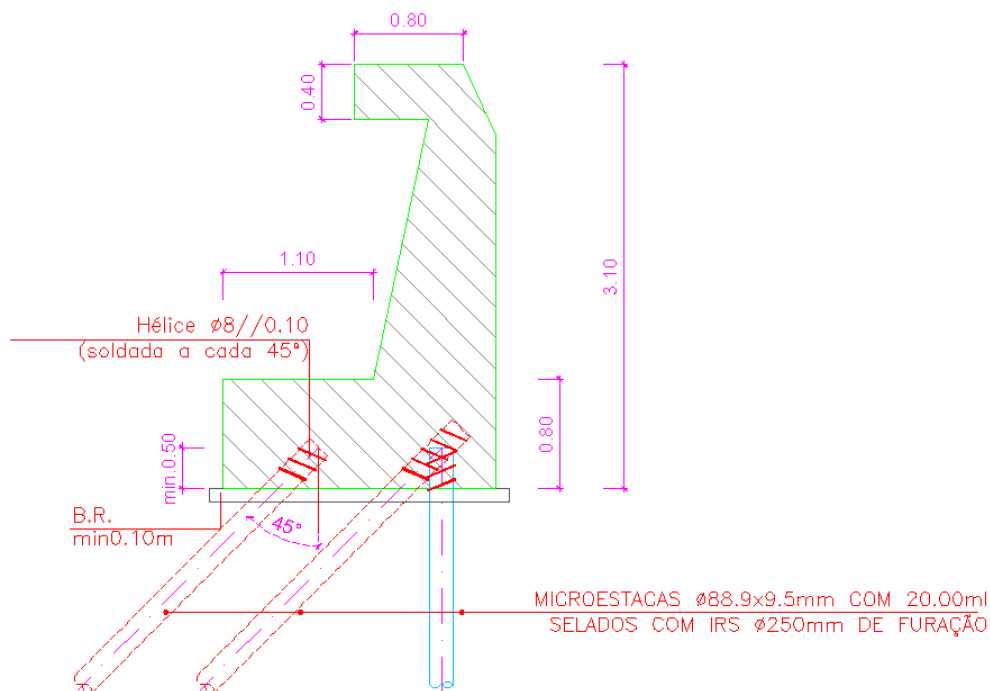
Corte transversal para fundações indiretas da ponte pedonal até 14,0m de vão
